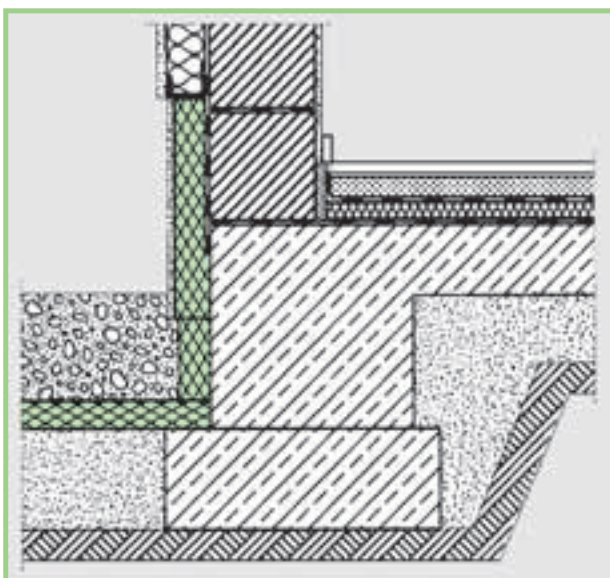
Possibilità di isolamento delle fondamenta contro il gelo.
